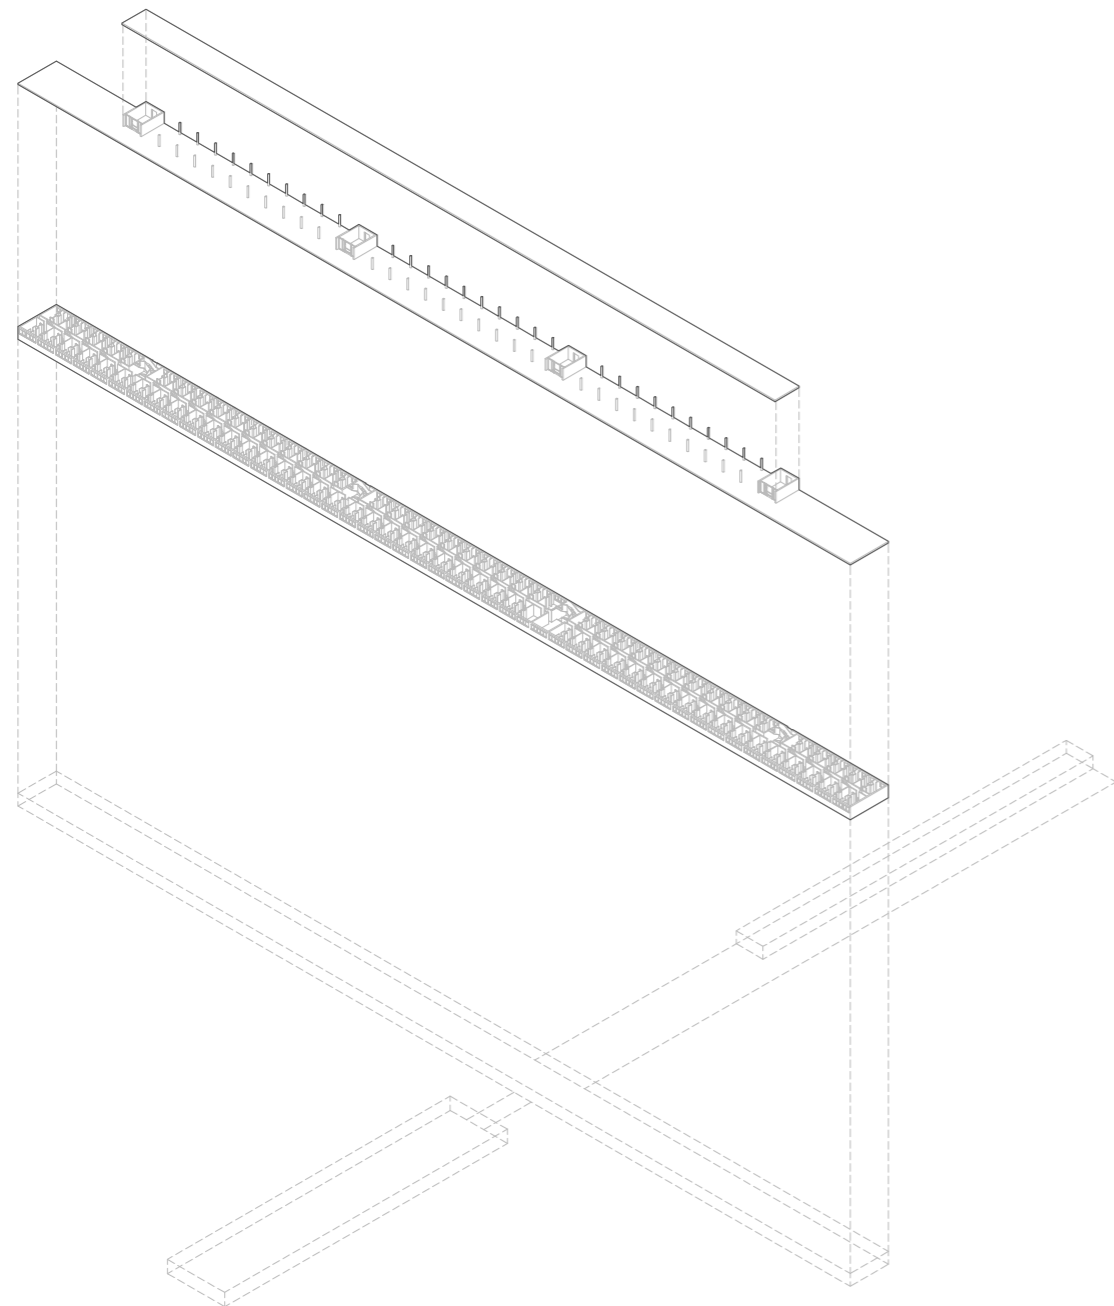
Axonometría seccionada a nivel. Planta décima y cubierta.
